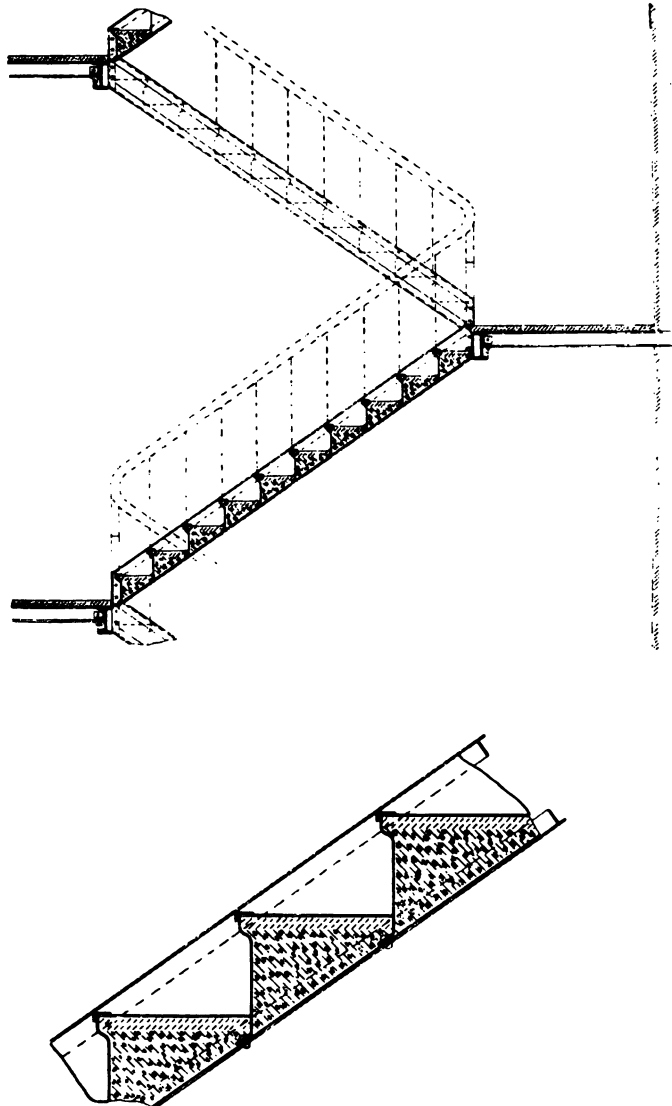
Treppe und Schnitt durch einige Treppenstufen aus Beton zwischen Eisen
